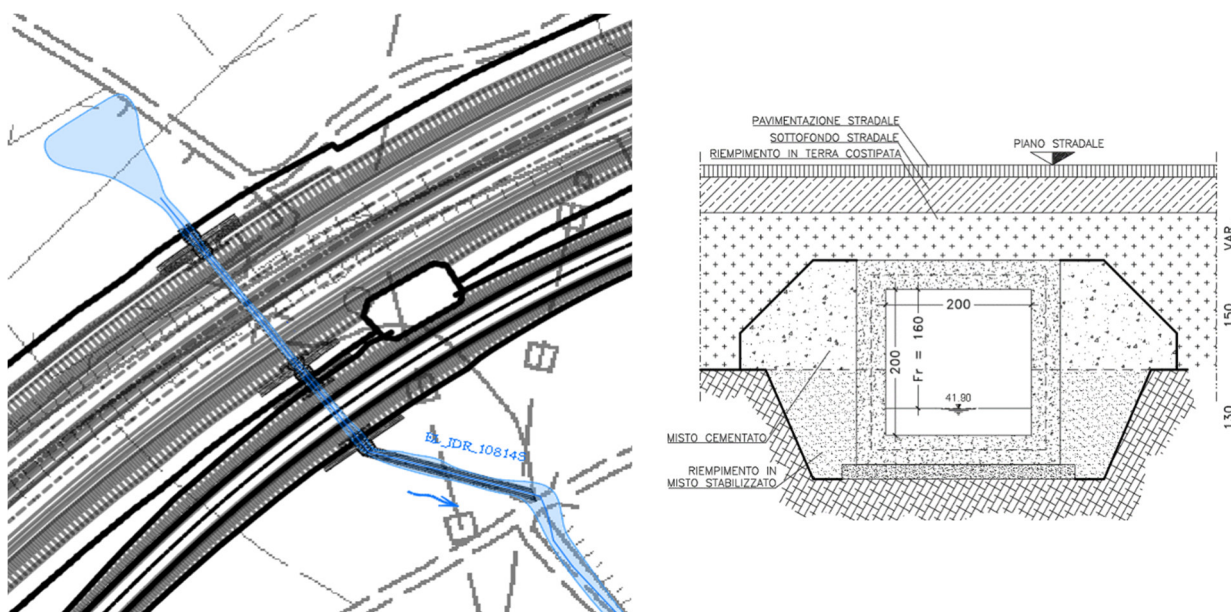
Situazione Post Operam, eliminazione degli allagamenti a monte dei rilevati stradali
